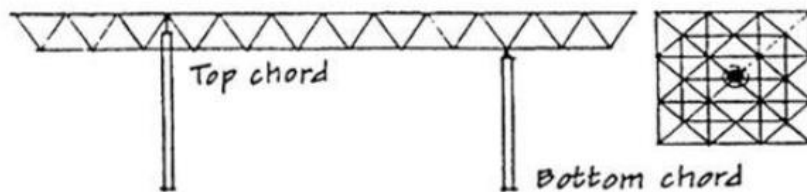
Bantalan penopang Space Frame type elastomeric pad
